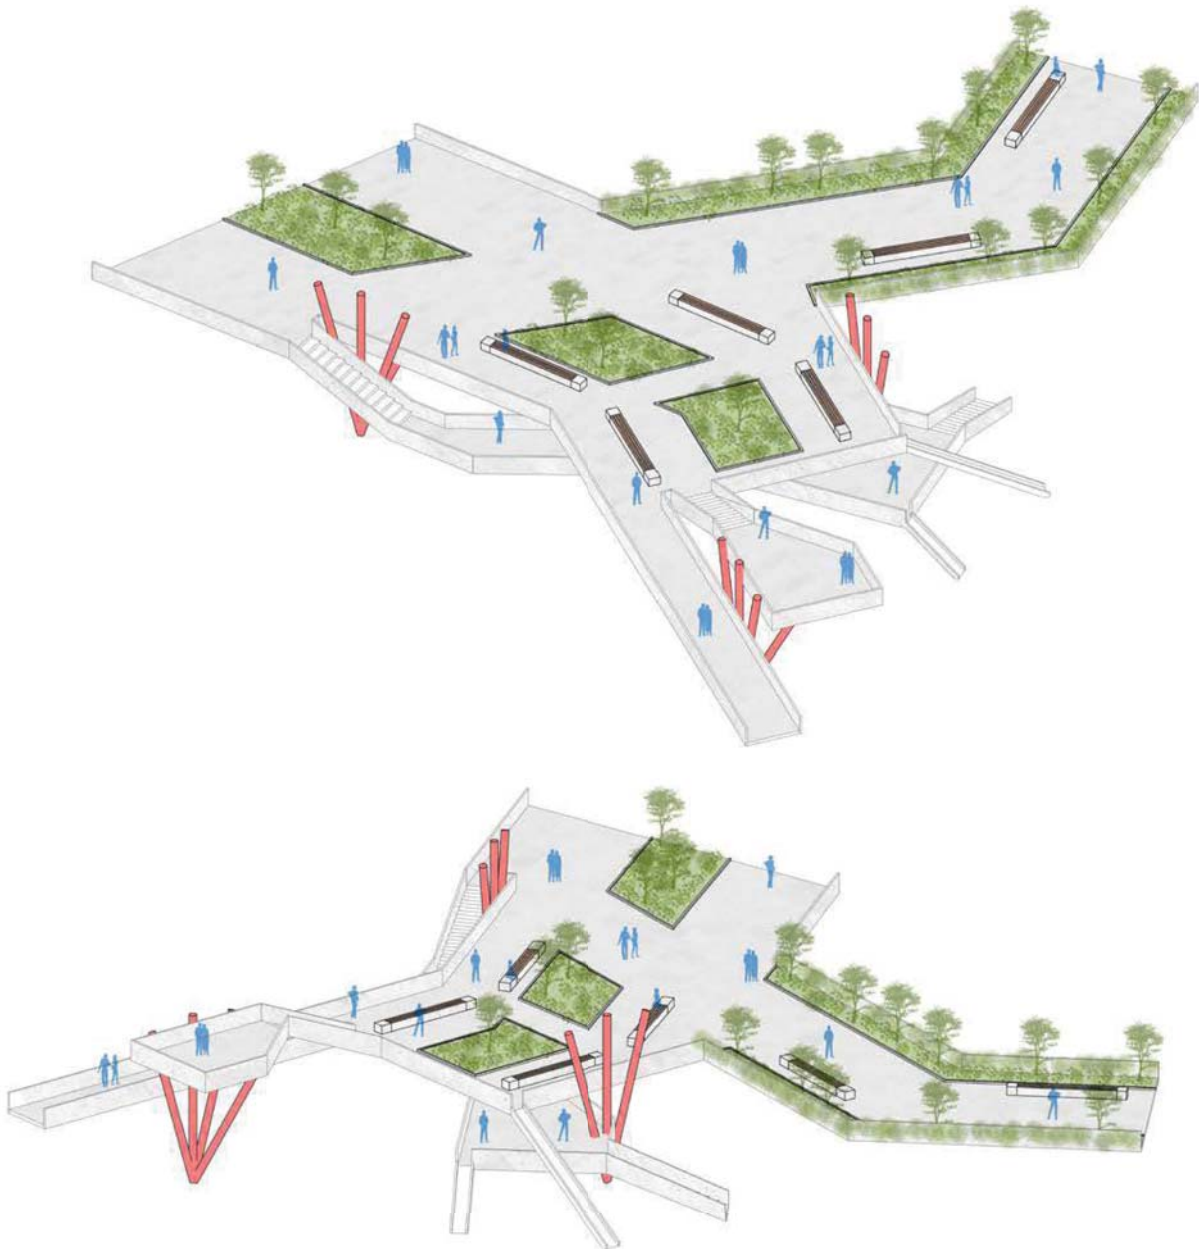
Esquema remarcando la estructura metálica con la estructura de hormigón.
